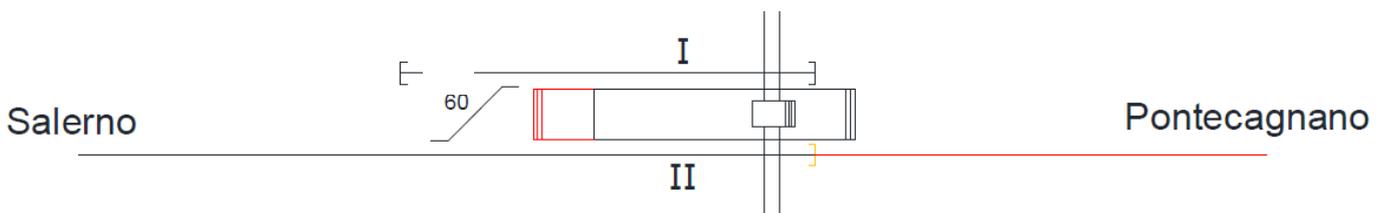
Stralcio dello Schema funzionale Fermata Arechi
